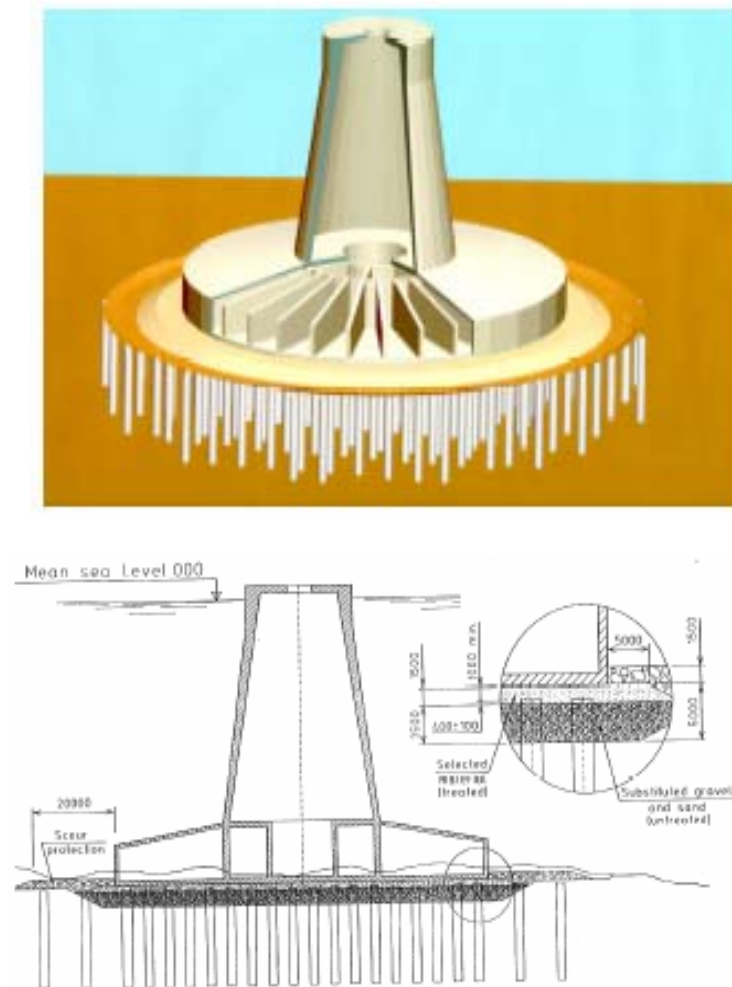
Zapata Típica y cimentación a base de inclusiones del Puente Rion-Anthion
